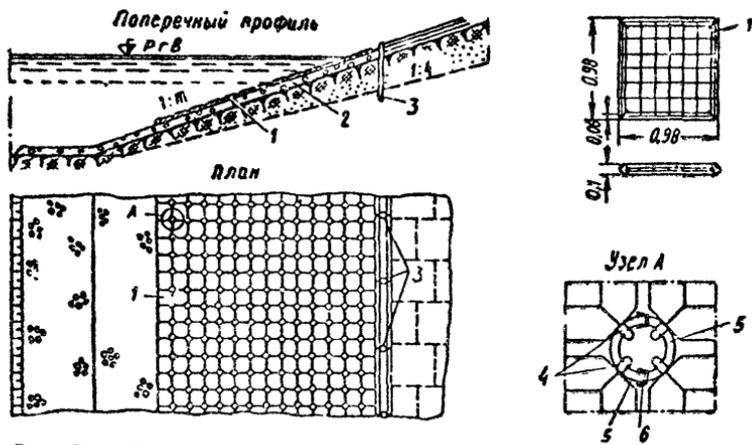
Конструкция крепления откоса гибким тюфяком из железобетонных плит:
